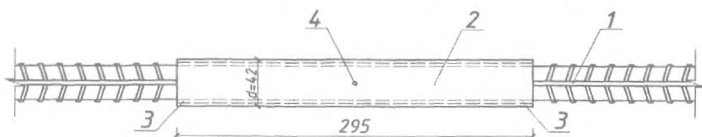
Конструкция муфтового соединения стержневой арматуры (Тип № 2, 3)
